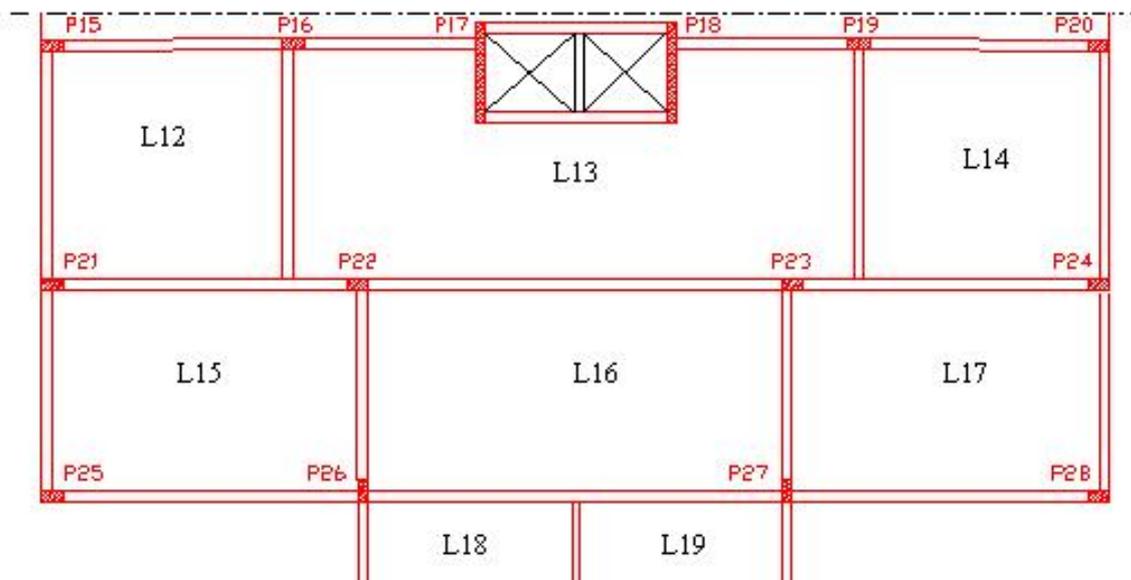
Trecho de uma planta de fôrmas de um pavimento tipo
